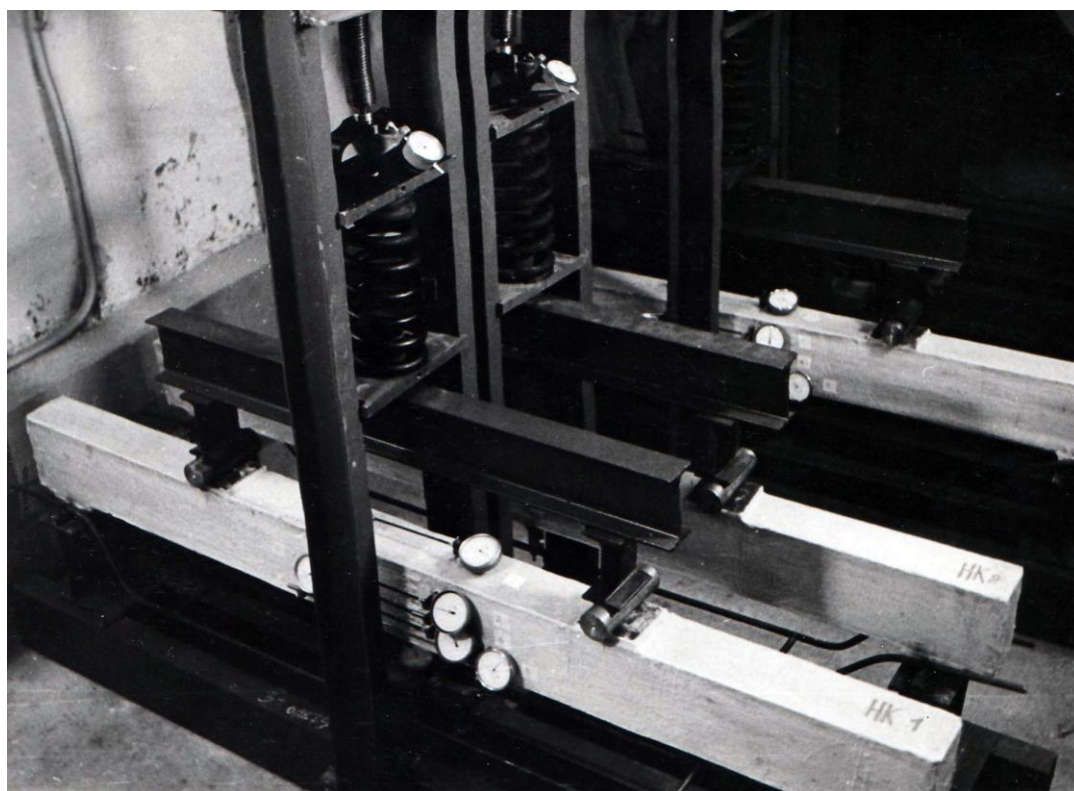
Пружинные установки для испытания армированных ячеистобетонных балок размером 10x16x180 см
